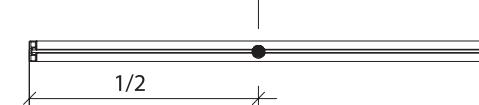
Rzut poziomy (z góra)/ Top view (plan view)
